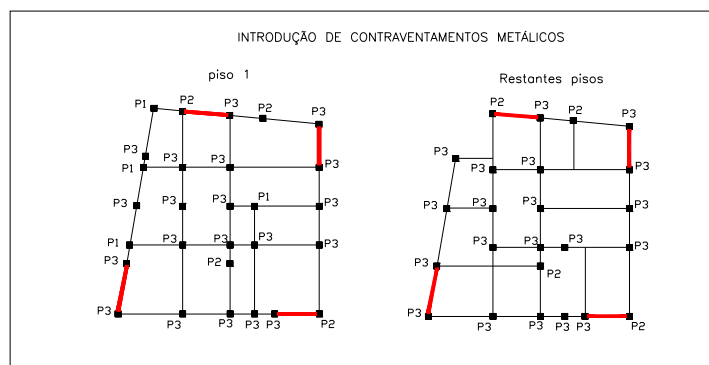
Planta estrutural do edifício reforçado com introdução de contraventamentos metálicos.
